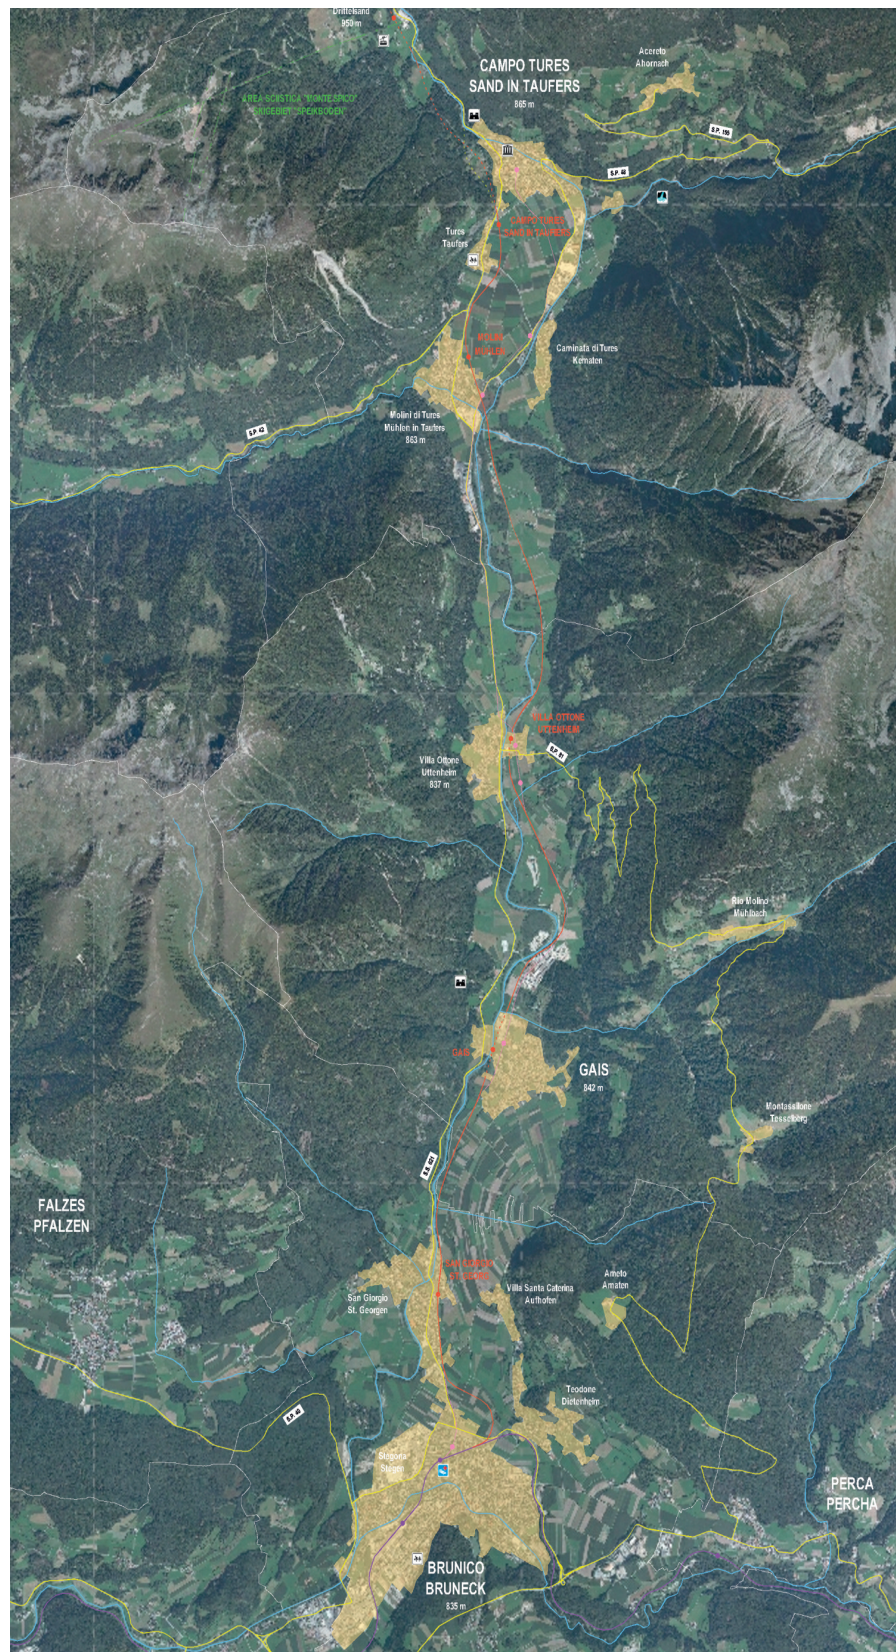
Andamento planimetrico lotto 1, Brunico-Campo Tures.
